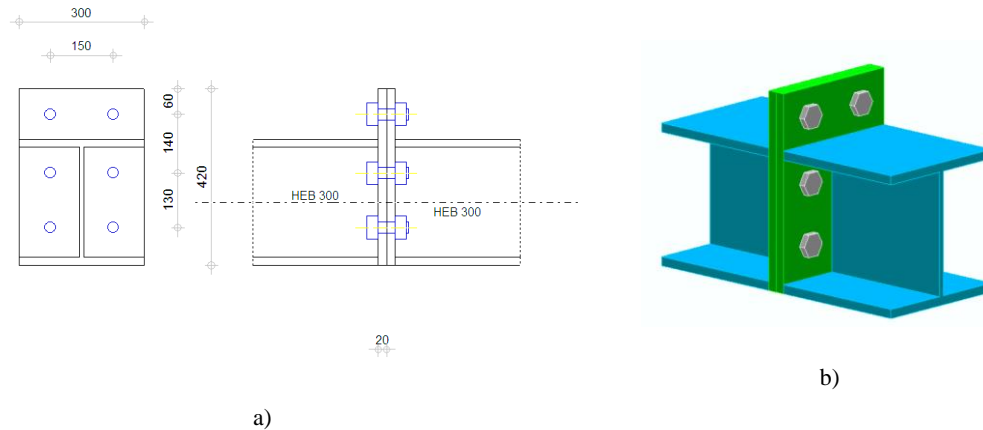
a) Esquema da ligação aparafusada viga-viga; b) Esquema 3D da ligação aparafusada viga-viga.
